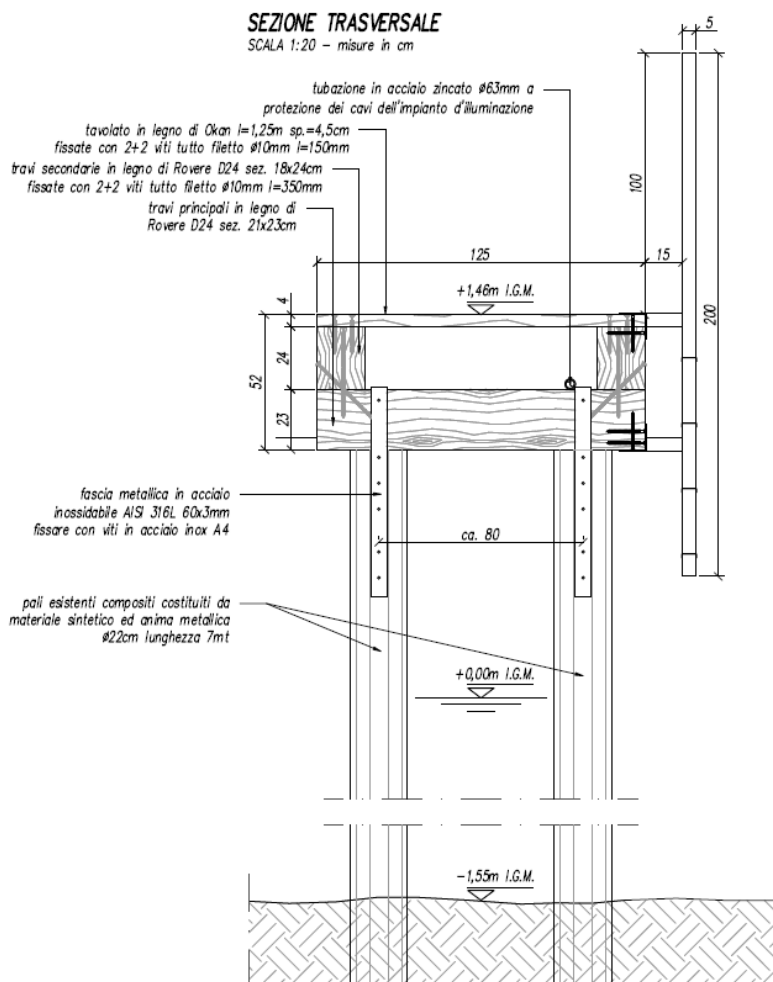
Sezione tipologica di progetto del pontile
